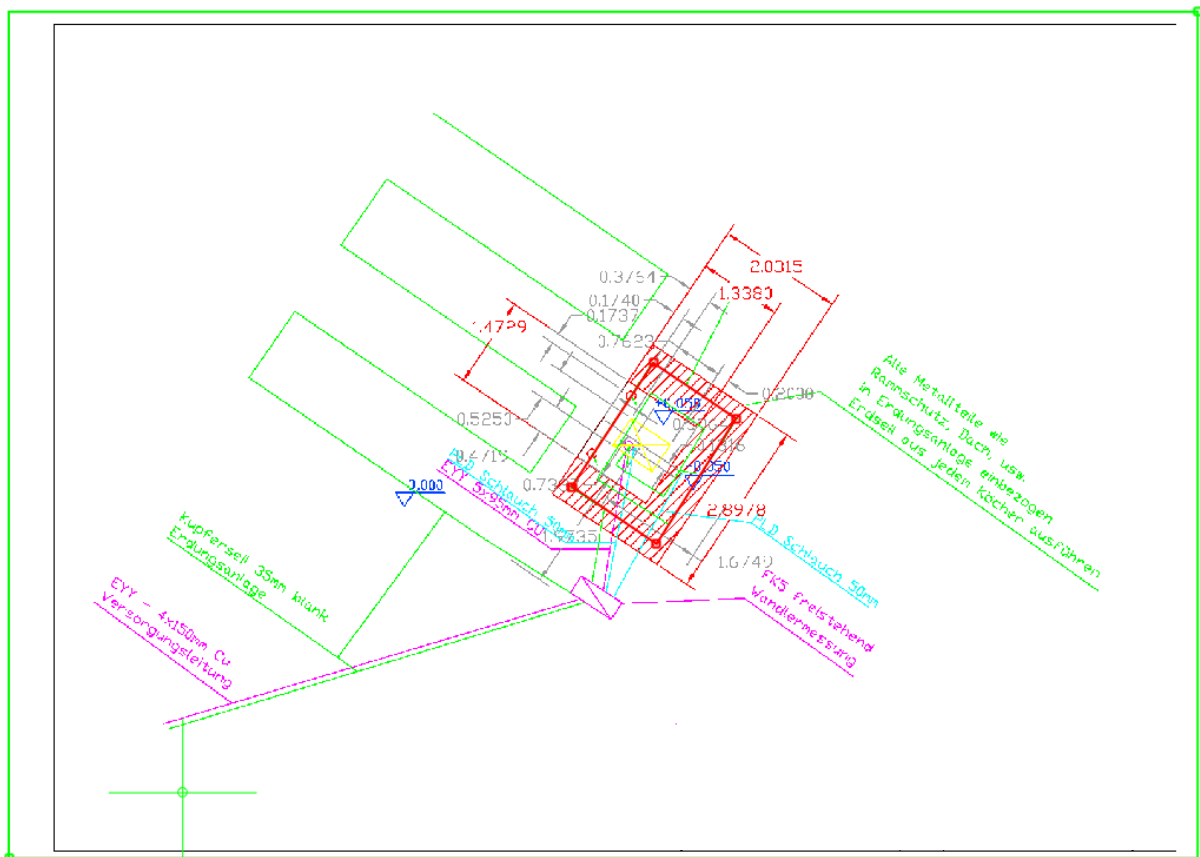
Grundriss Variante 1 (vgl. [36])
